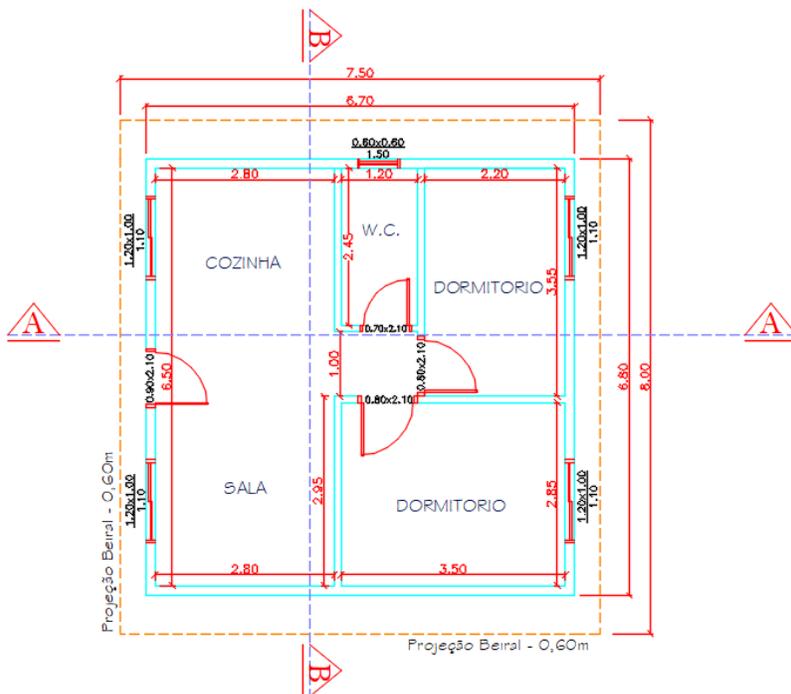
Planta baixa desenvolvida no AutoCAD (Próprios autores, 2020)
